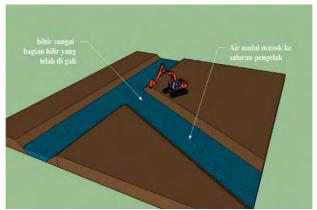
34. Bendung Pengelak Tahapan pekerjaan bendung pengelak yaitu :
